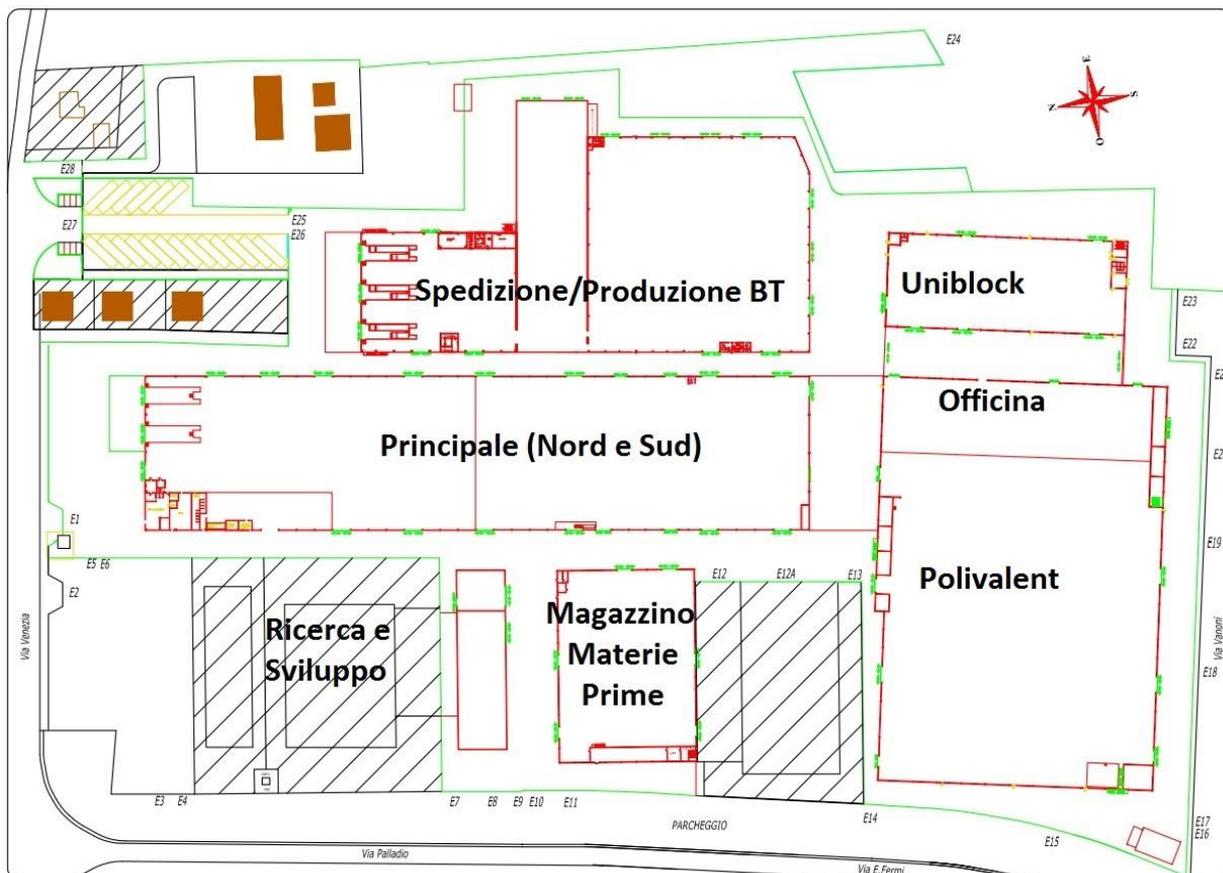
Planimetria sito produttivo Arneg S.p.A.
